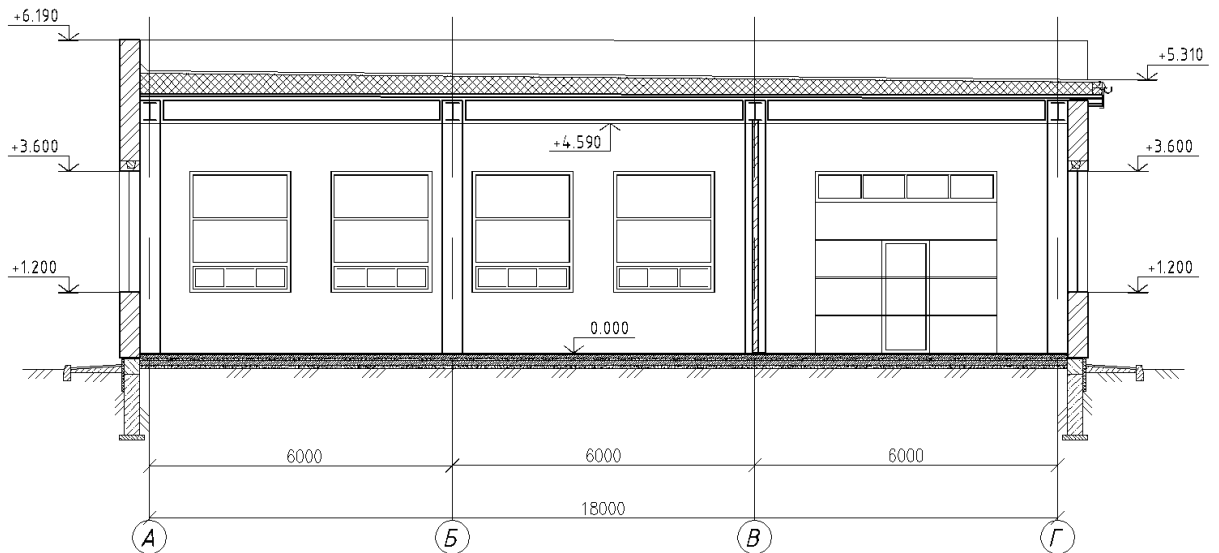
Схема будівлі для розрахунку зовнішньої організованої системи водовідведення дощових вод з покрівлі будинку.
